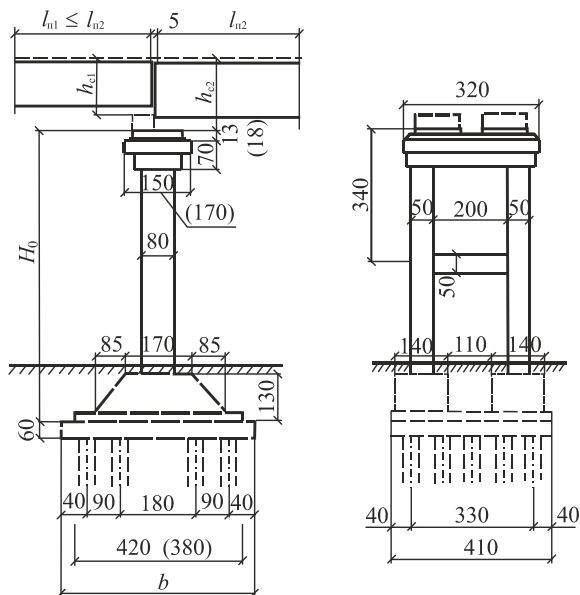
Схема опоры с вариантом свайного фундамента на 20 свай
